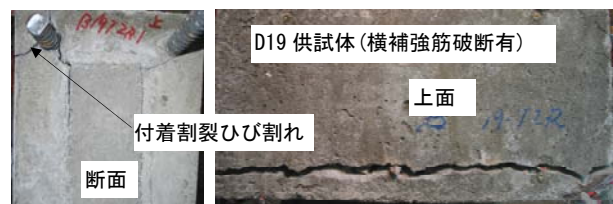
載荷後の付着割裂ひび割れ状況
